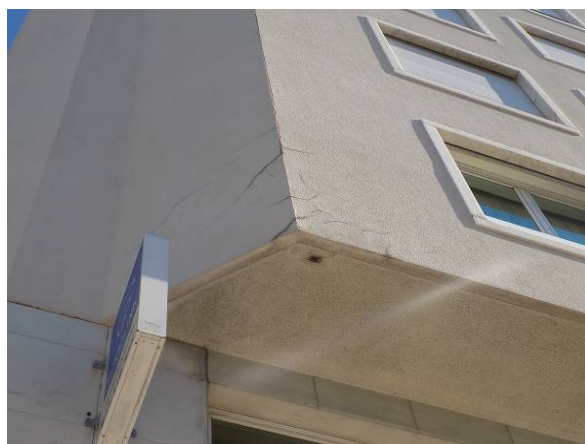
Idem. Idem. Pormenor da fachada com fissuração predominantemente horizontal em zona corrente de alvenaria de tijolo.
